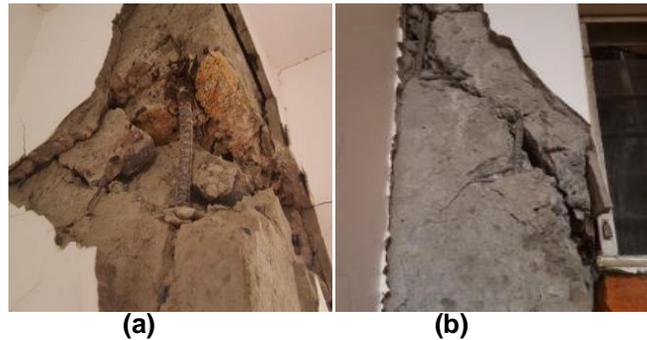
Daño en columnas, (a) En la misma columna 8b se observa pandeo del refuerzo vertical debido a un excesivo espaciado de estribos, (b) se observa una falla por cortante en la columna que soporta la grada debido a una excesiva separación de los estribos, no formaba parte del sistema resistente.
